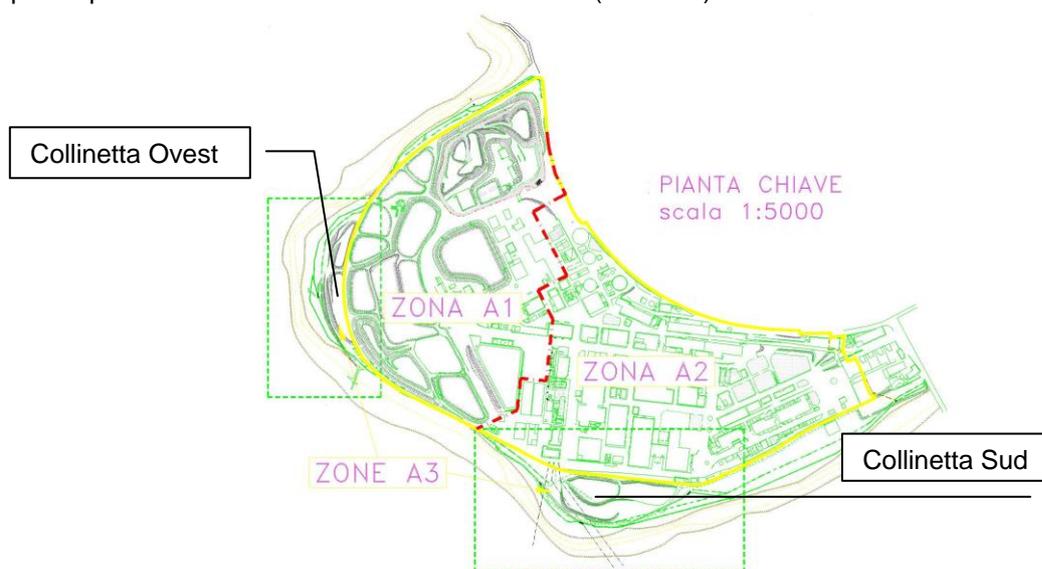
Estratto da planimetria catastale dello stabilimento di Cengio con ubicazione delle cosiddette "collinette"
